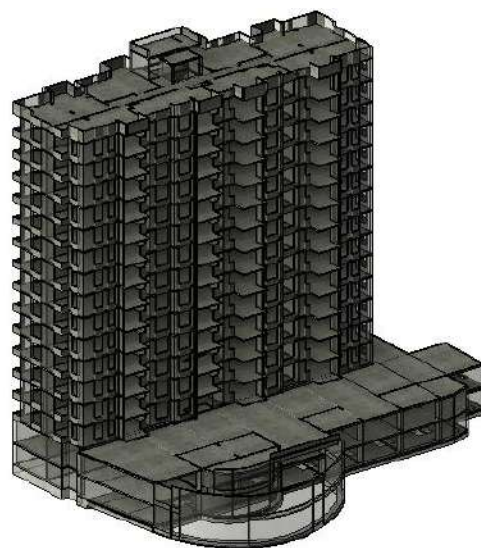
Edificio Parque Peñablanca Revit, cortesía de Carvallo Ingeniería Cálculo Estructural.
